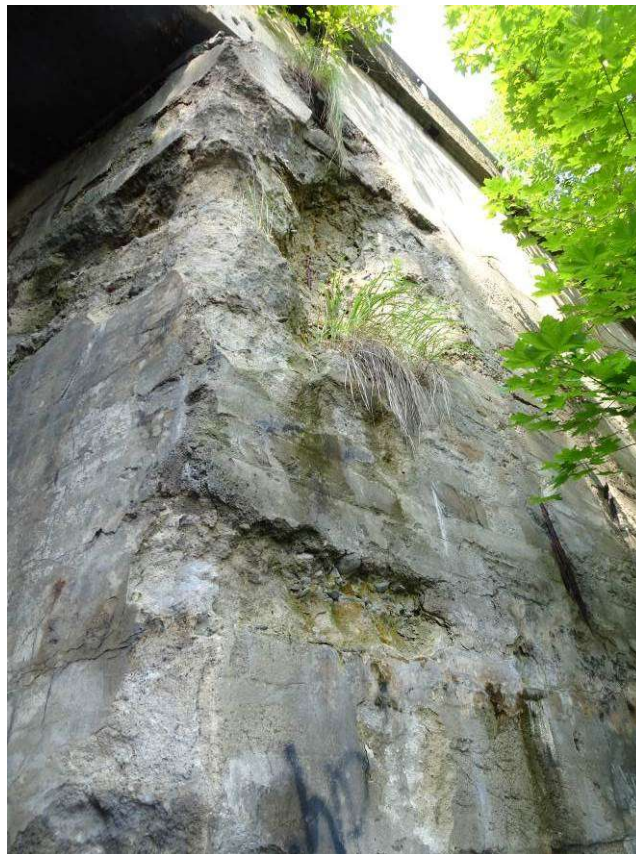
Przyciótek północno-zachodni. Ubytki betonu
